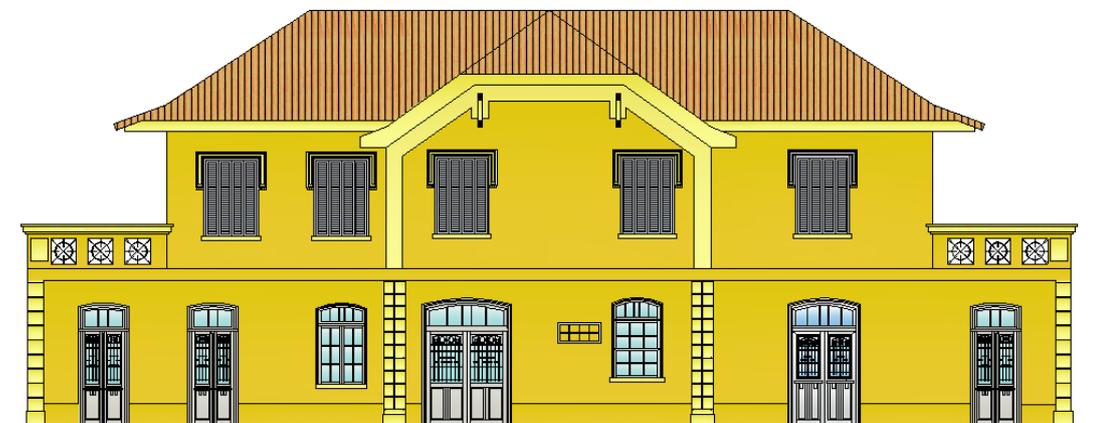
Fachada frontal da Estação ferroviária de Santiago.
